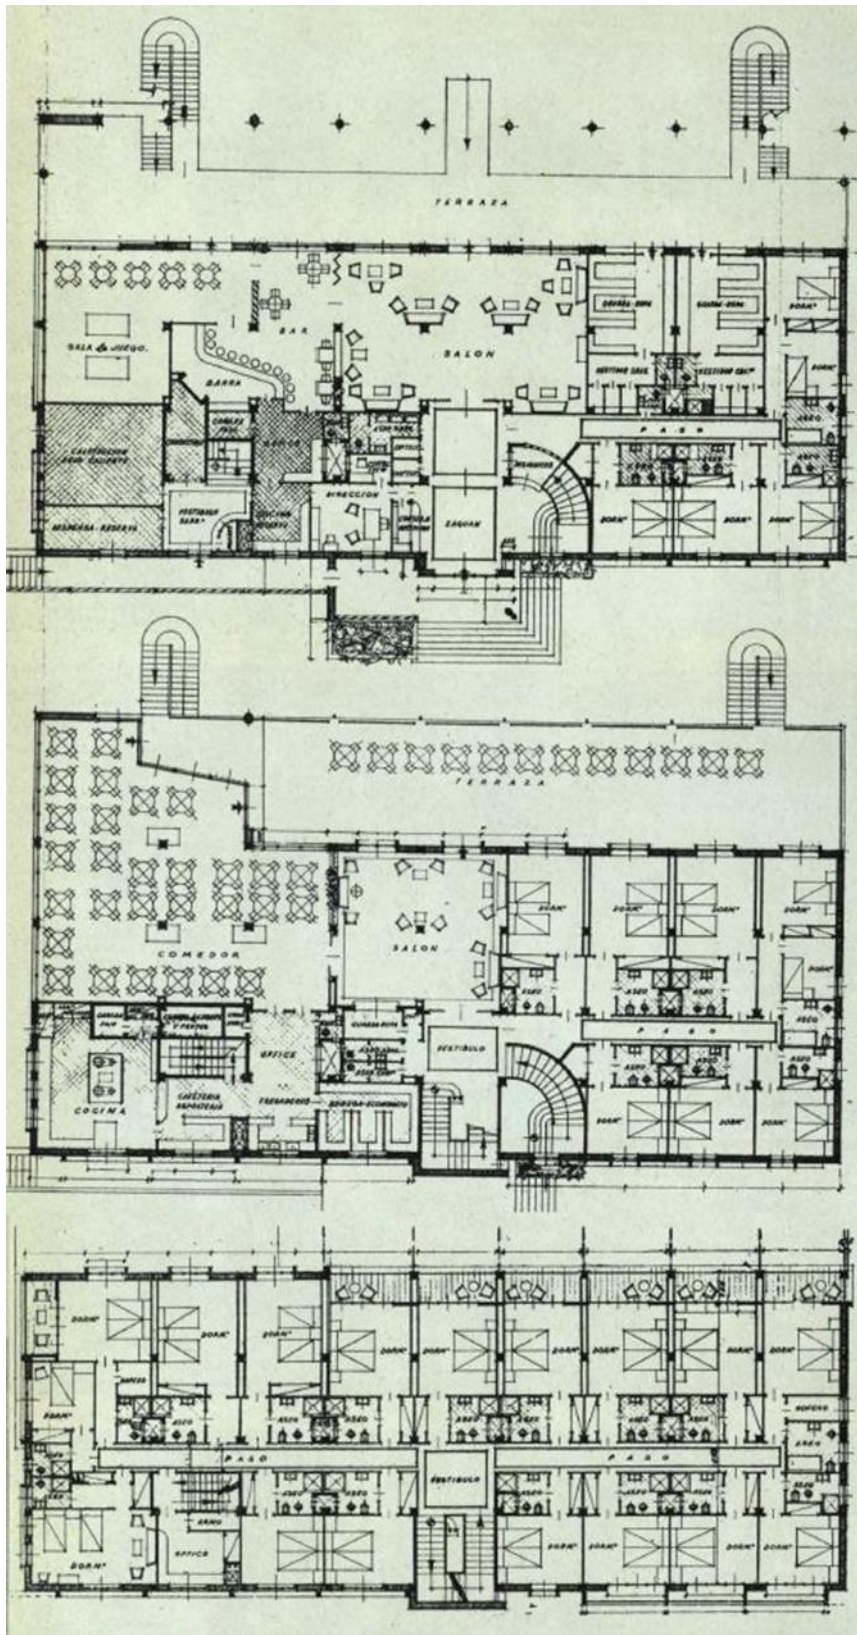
Planta baja, primera y segunda del hotel Recatí (1955). Luis Gay.
